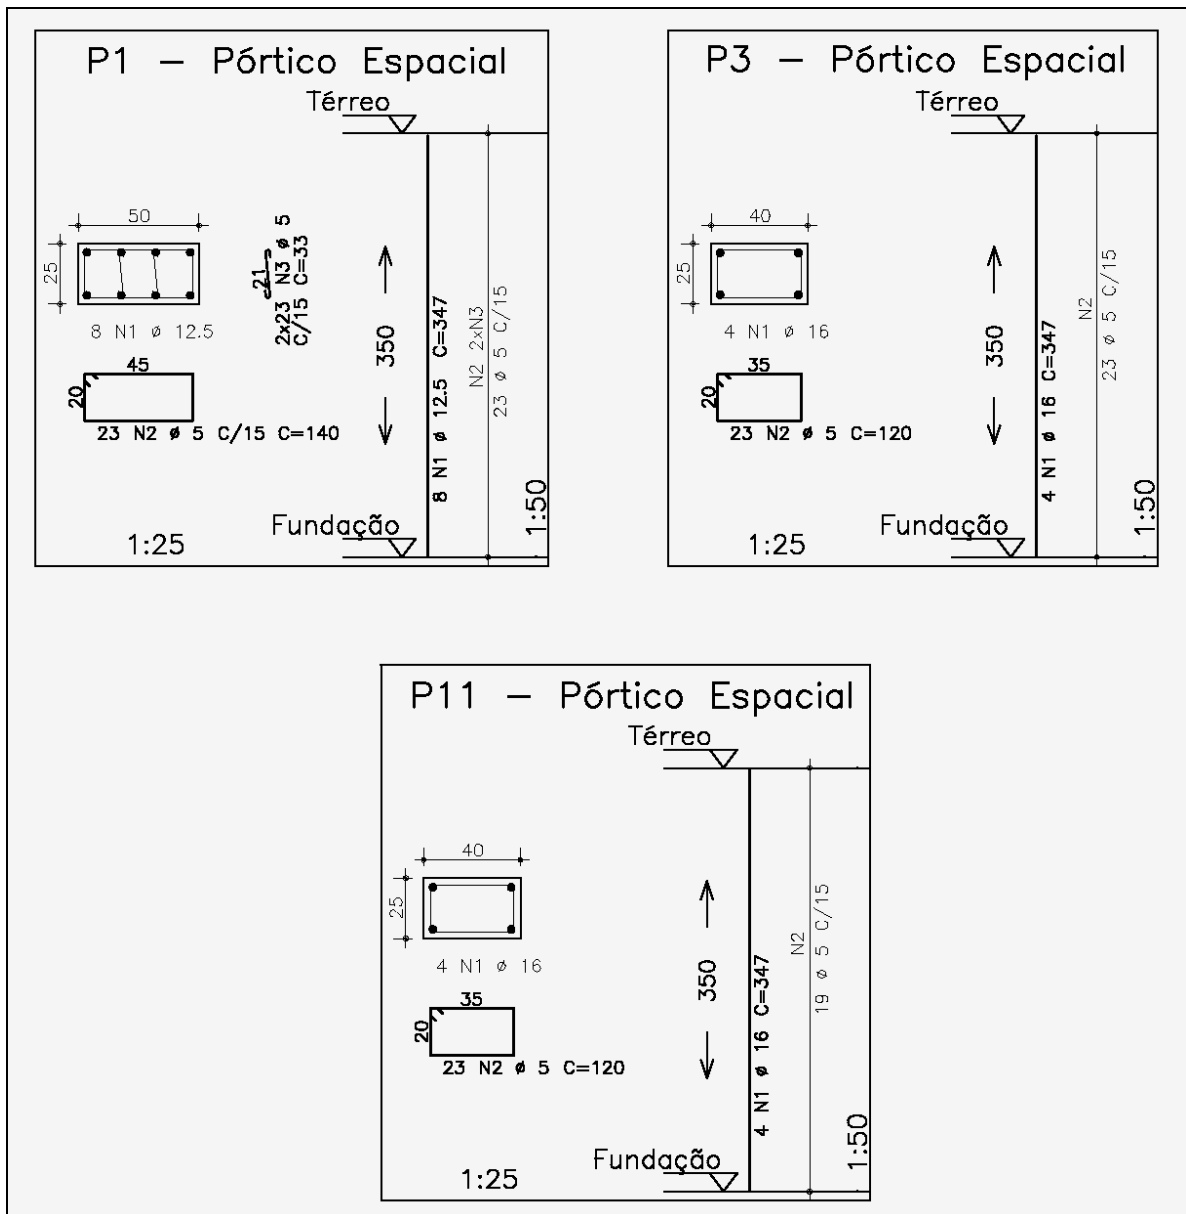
armaduras dos pilares pelo modelo de pórtico espacial
